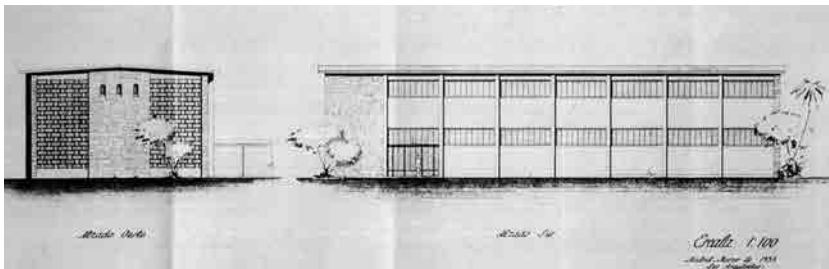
, Fig. 75 y Fig. 76 Pabellón de exposiciones. Alzado de la fachada Oeste (izquierda), alzado de la fachada Sur (centro) y vista general del edificio (derecha, fotografía actual).
